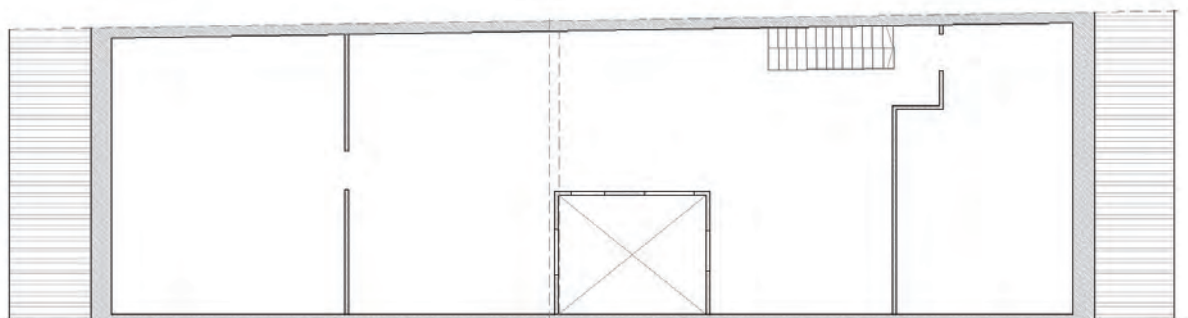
10. PLANTA BAJOCUBIERTA
